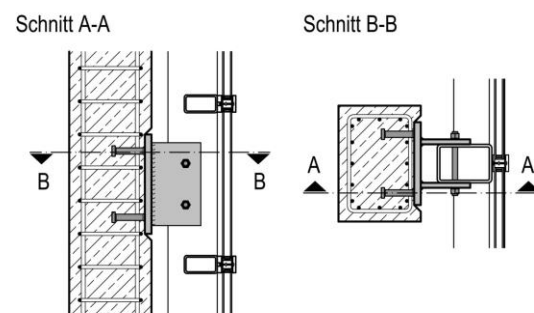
Fassadenanschluss an einer Betonstütze nach Kuhlmann u.a. (2018a)
